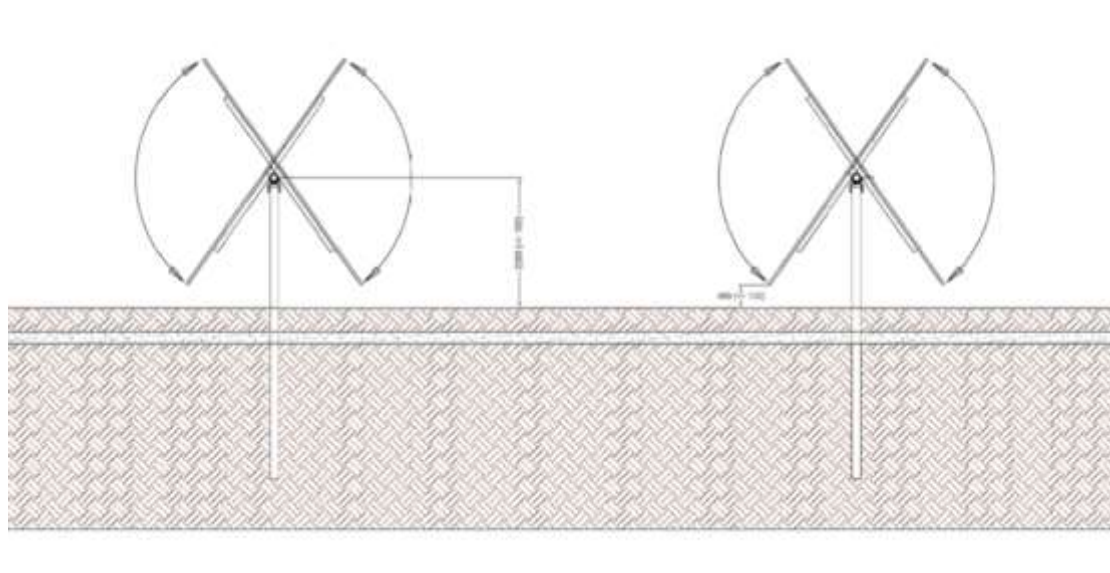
Rappresentazione tipo struttura di supporto
